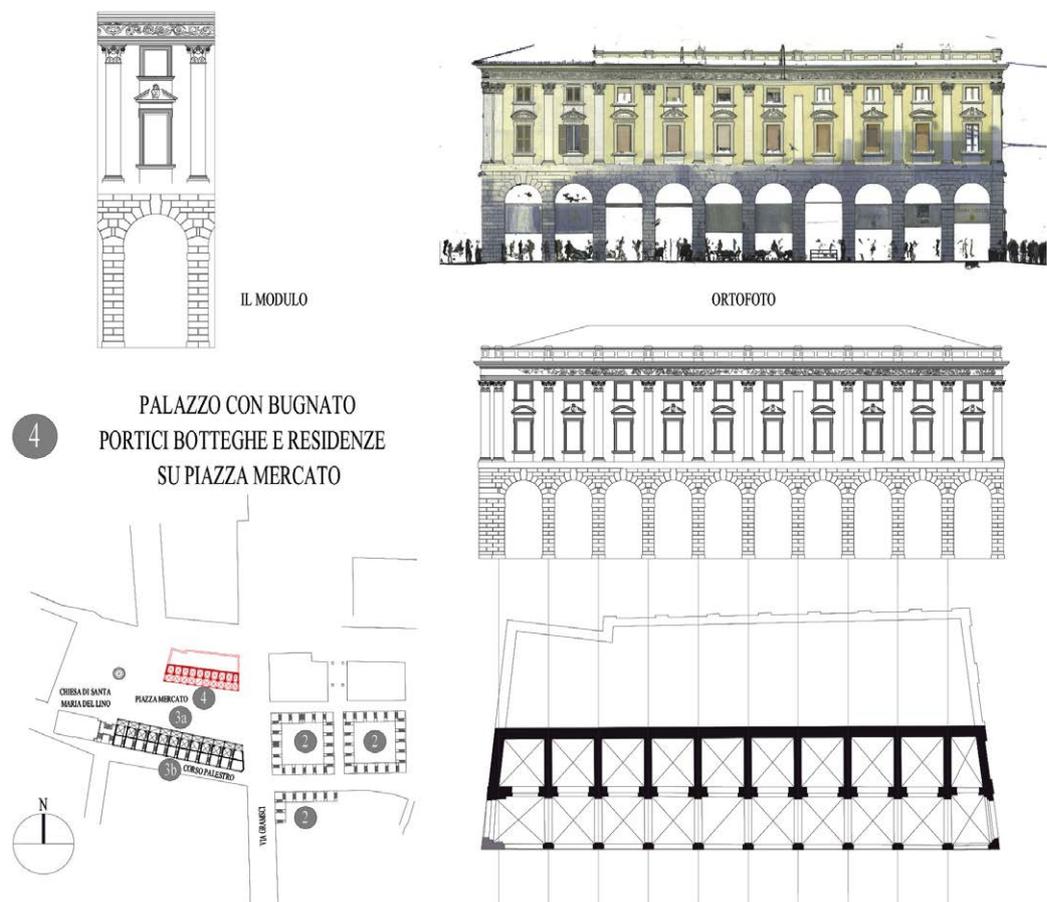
Brescia, piazza Mercato. Palazzo con bugnato: prospetto e pianta del portico e ortofoto. Elaborazione degli autori.
